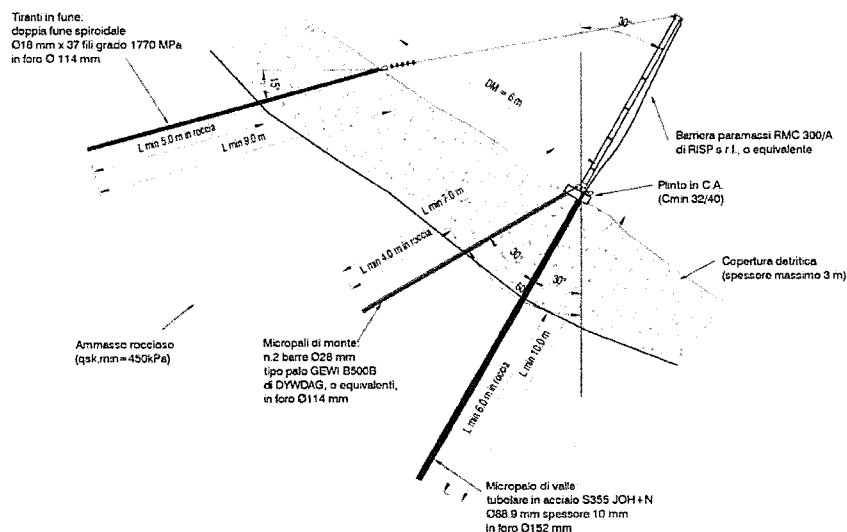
Sezione tipologica delle strutture di fondazione della barriera paramassi.
